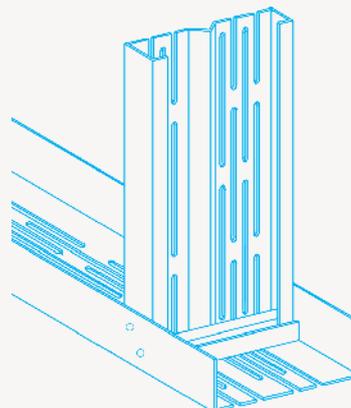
Muro portante utilizando una estructura de acero ligero con montantes ranurados (SCI).
